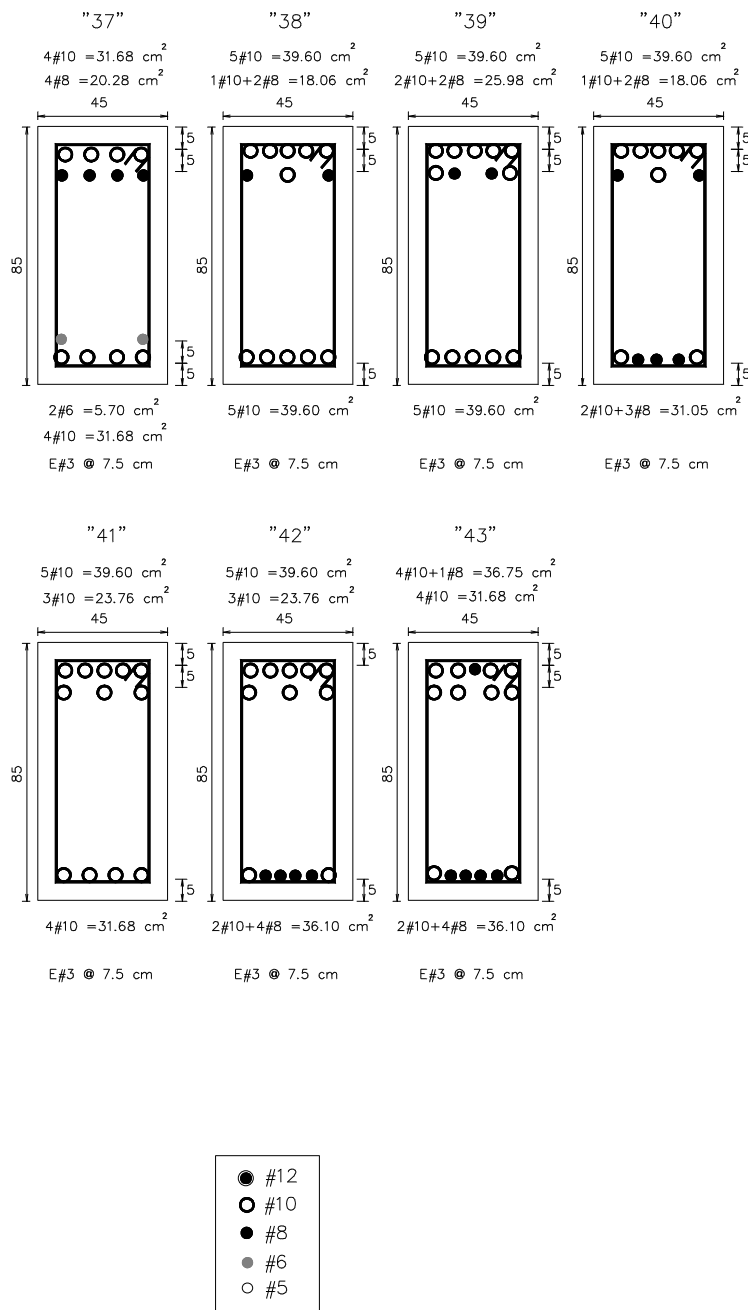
Tipos de armados propuestos para los extremos de las vigas del eje 2, estructuras de 17 niveles diseñadas en zona III (RDF-93 y RDF-04)
